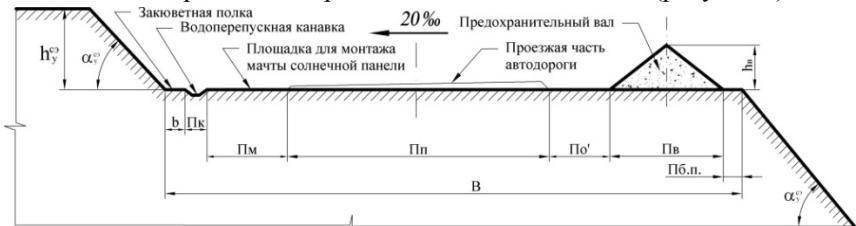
Конструкция горизонтальной транспортной бермы для монтажа:
